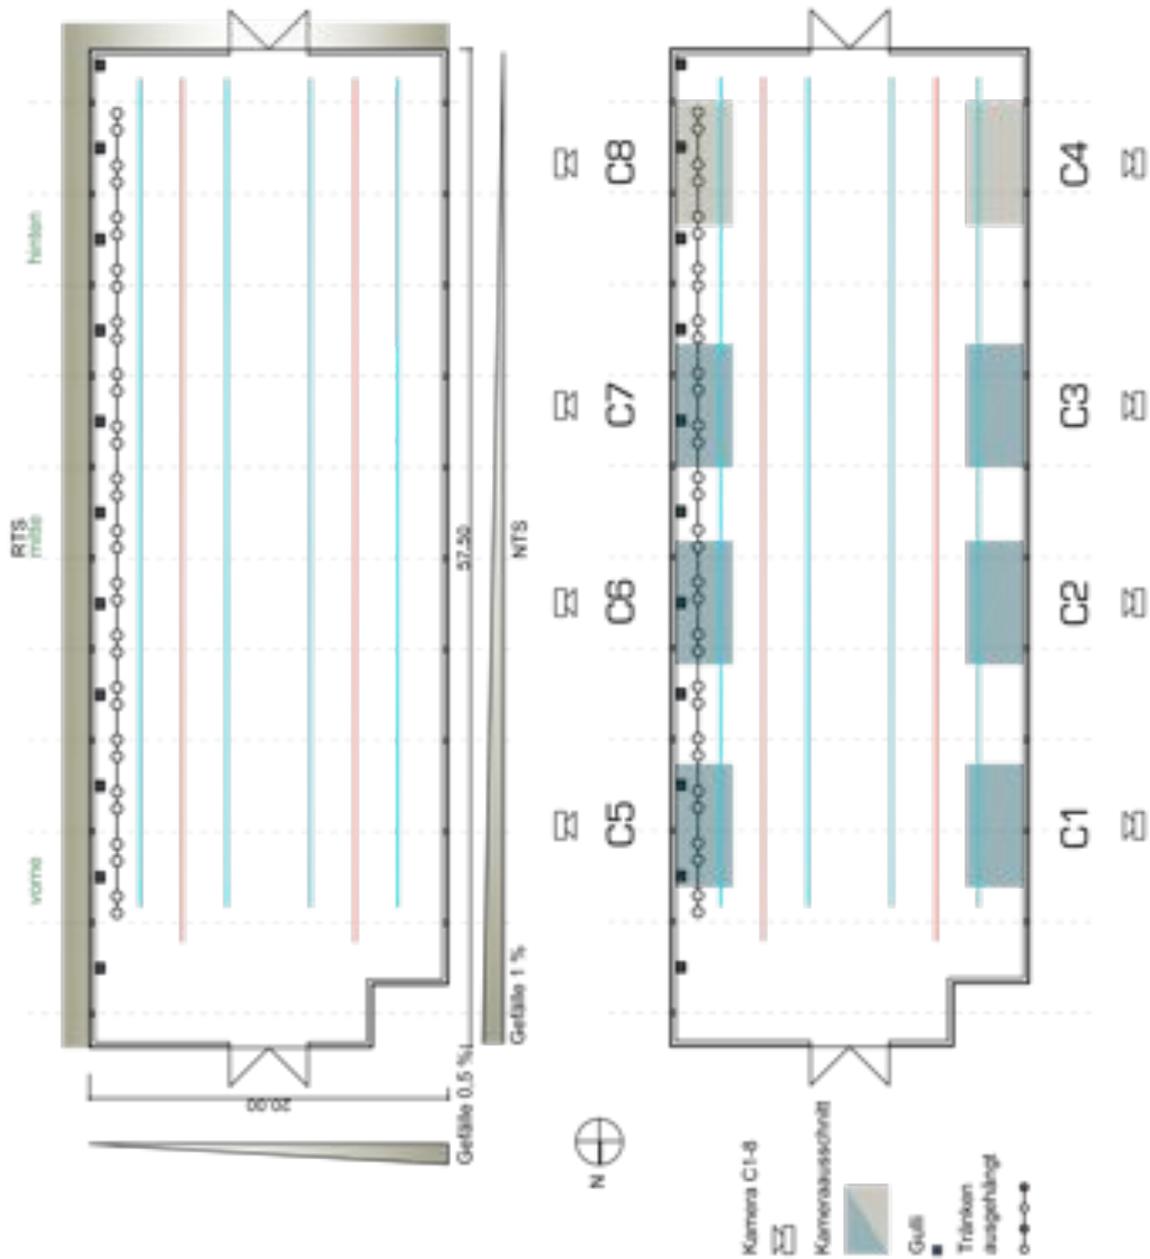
Betrieb 2: A Grundriss des Maststalls mit vier Nippeltränkenlinien, zwei Futterlinien und der Rundtränkenlinie an der östlichen Stalllängsseite; die Tiergesundheitsbeurteilung erfolgte beidseits vorne/in der Mitte/hinten im Stall (grün); B Videoauswertung mit den Kameraausschnitten der einzelnen Kameras C1 – C8; die reduzierte Anzahl der Kameras (hellgrau= reduziert) ist farblich gekennzeichnet; es konnten keine Durchgänge mit kompletter Rundtränkenanzahl verwendet werden
